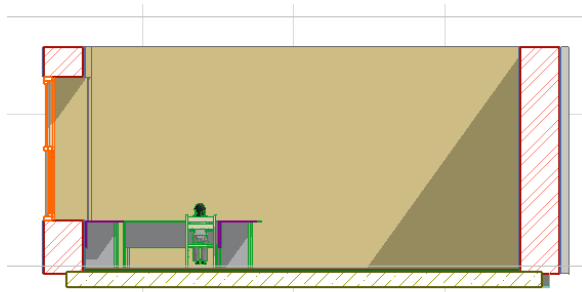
Поперечный разрез помещения с указанием рабочего места относительно оконных проемов
